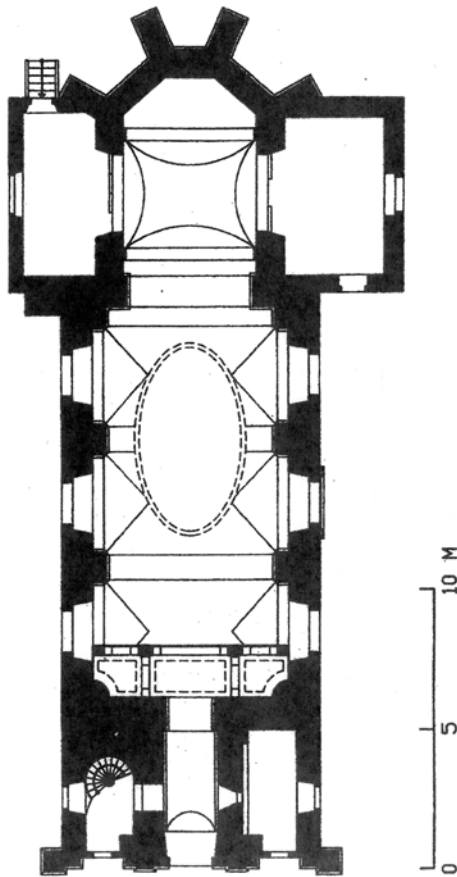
Rappoltenkirchen, Grundriss der Pfarrkirche
